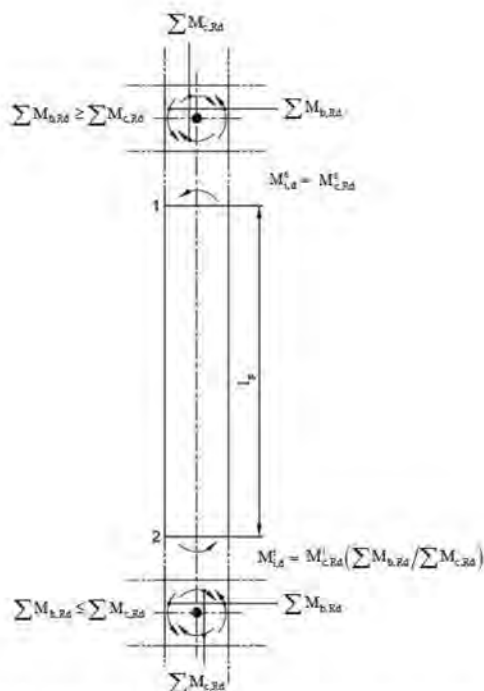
Equilibrio dei momenti per il calcolo delle sollecitazioni di taglio di progetto V_{Ed} nei pilastri.
